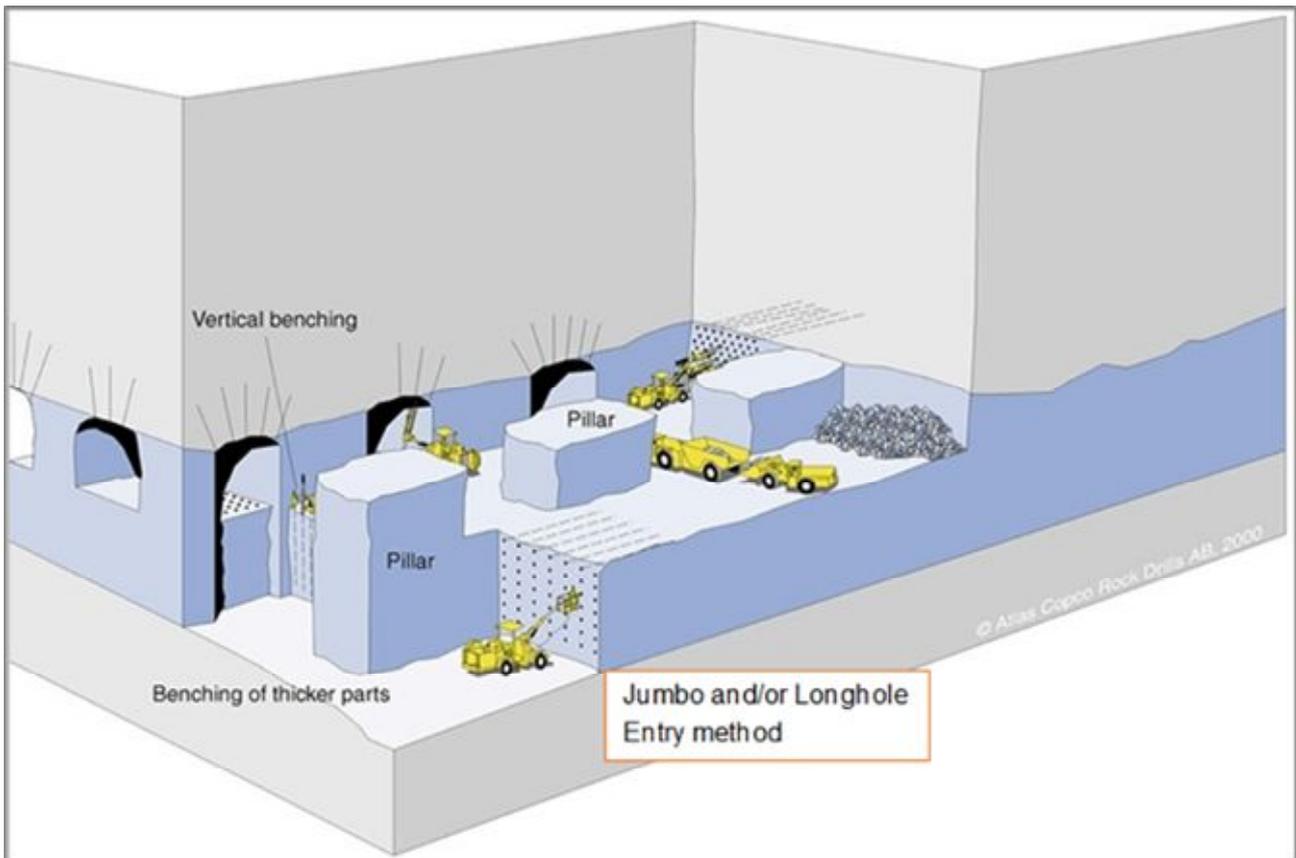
Schema del metodo di coltivazione "a camere e pilastri".
